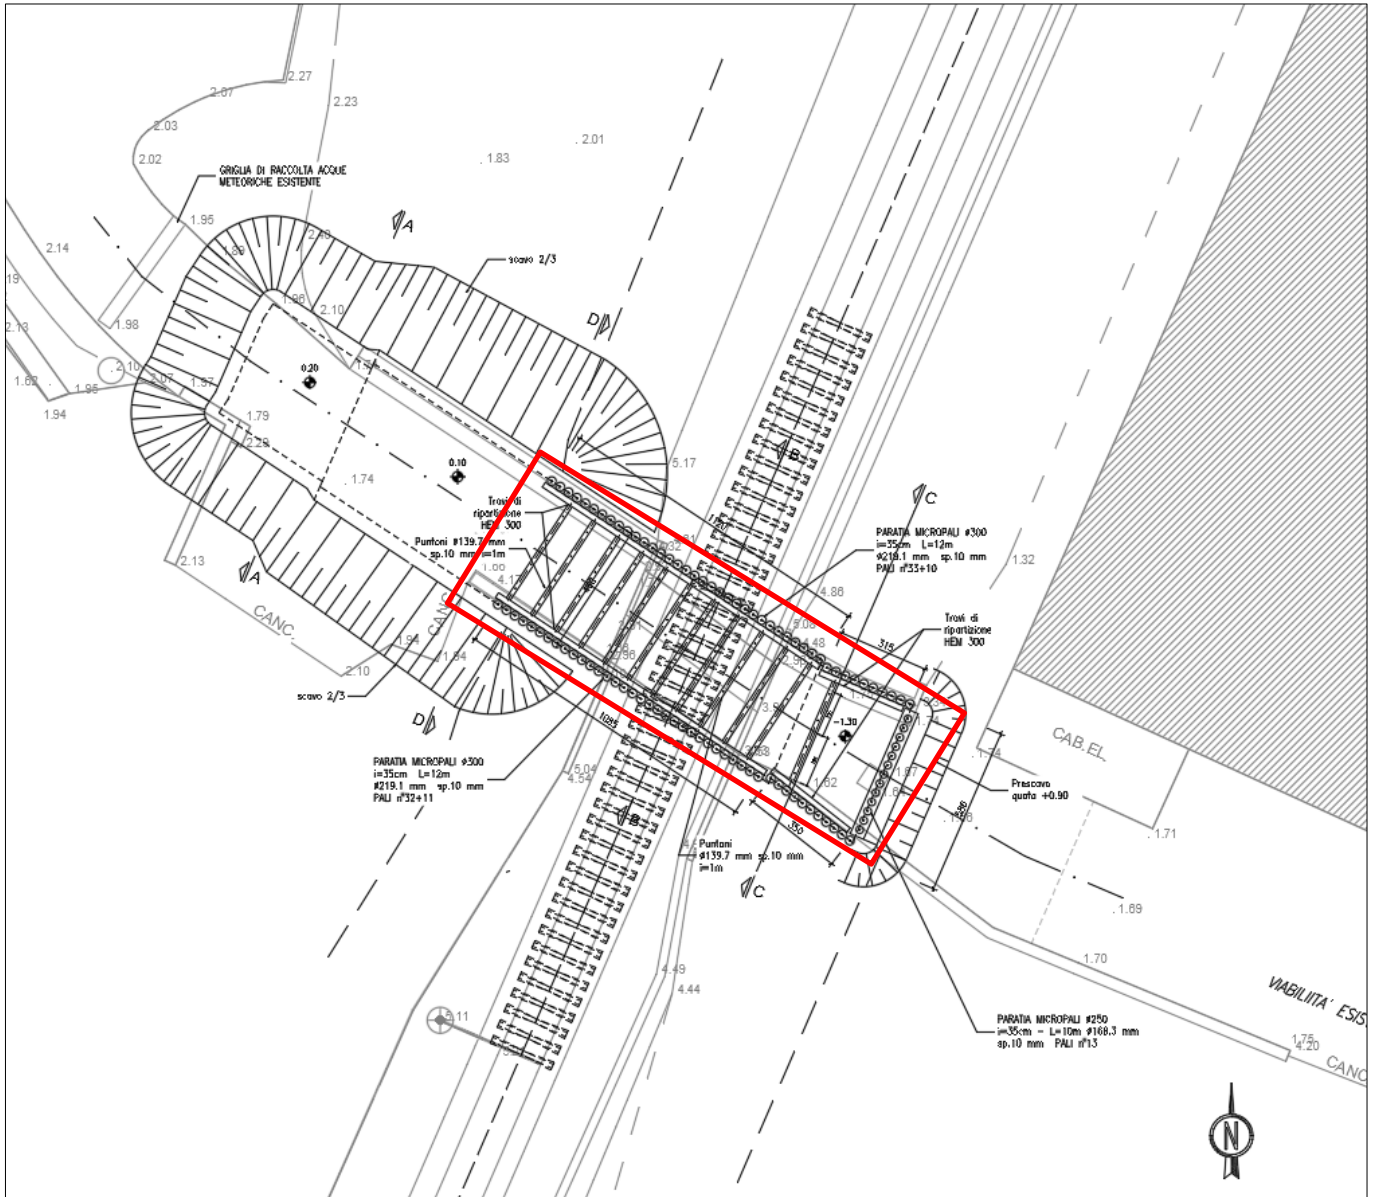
Planimetria di progetto – Sottovia SL02
